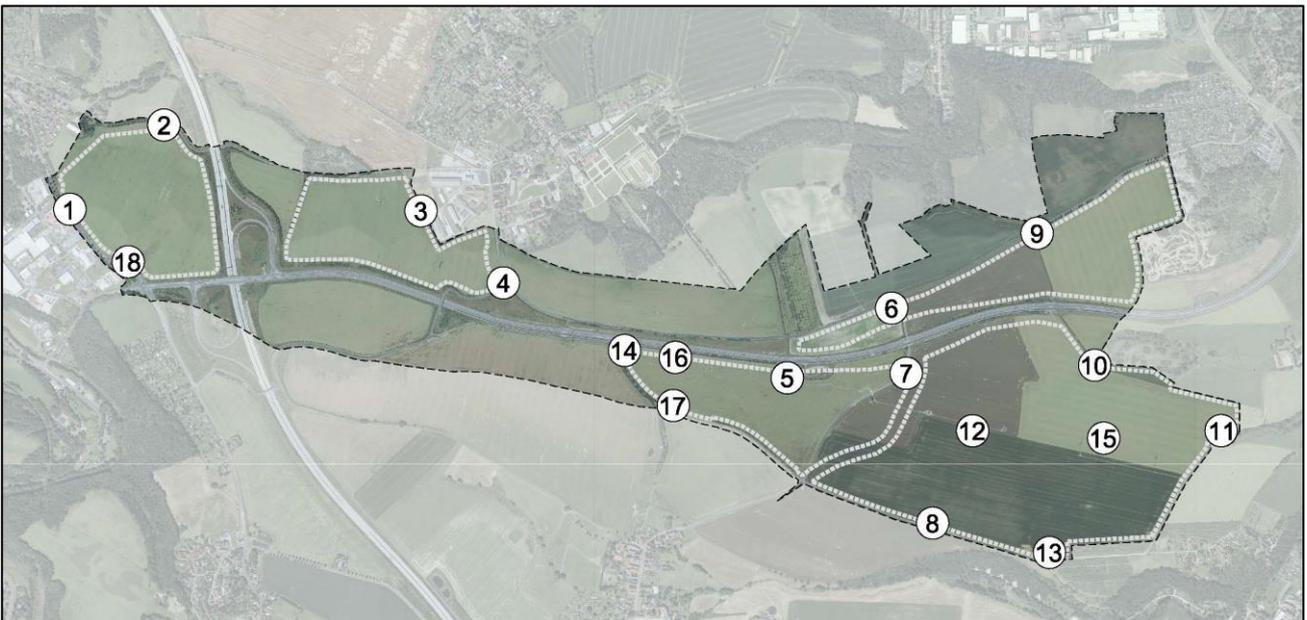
Übersicht der Bohrpunkte zum Baugrundaufschluss
